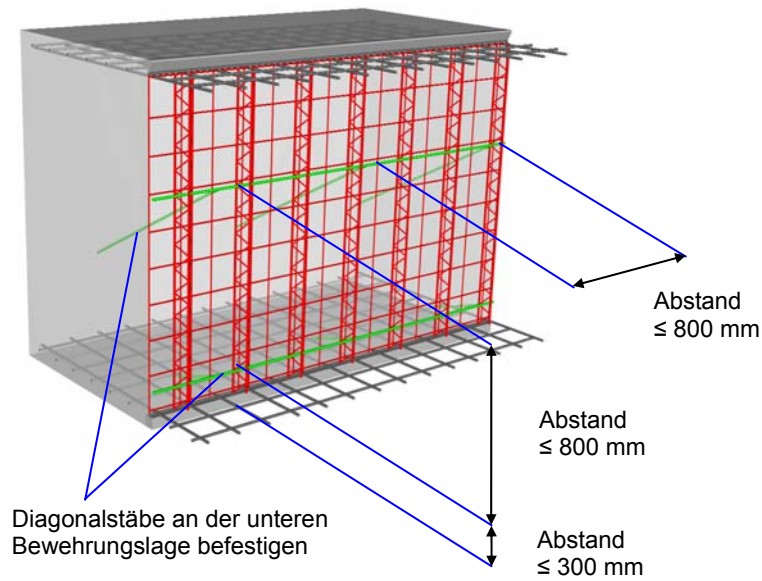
Detailansicht einer mit Stremaform geschalteten Fuge von 300 mm bis 500 mm Höhe
